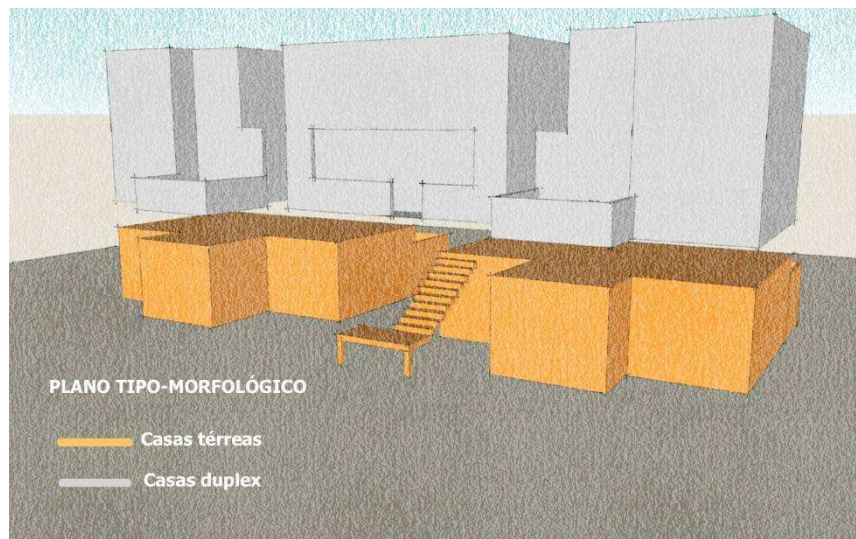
Plano Tipo-Morfológico – Tipos de casas
